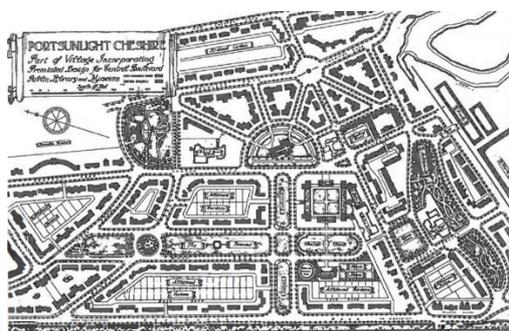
William Owen, Planimetria di Port Sunlight (1888-1910)
